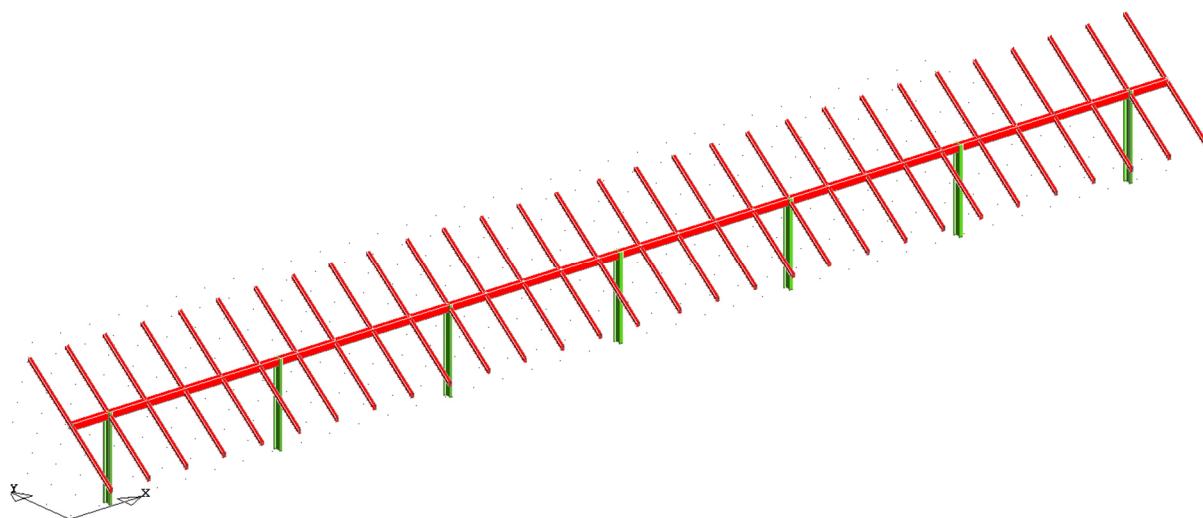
Vista assonometrica modello strutturale con posizione della “vela” inclinata di 55°
